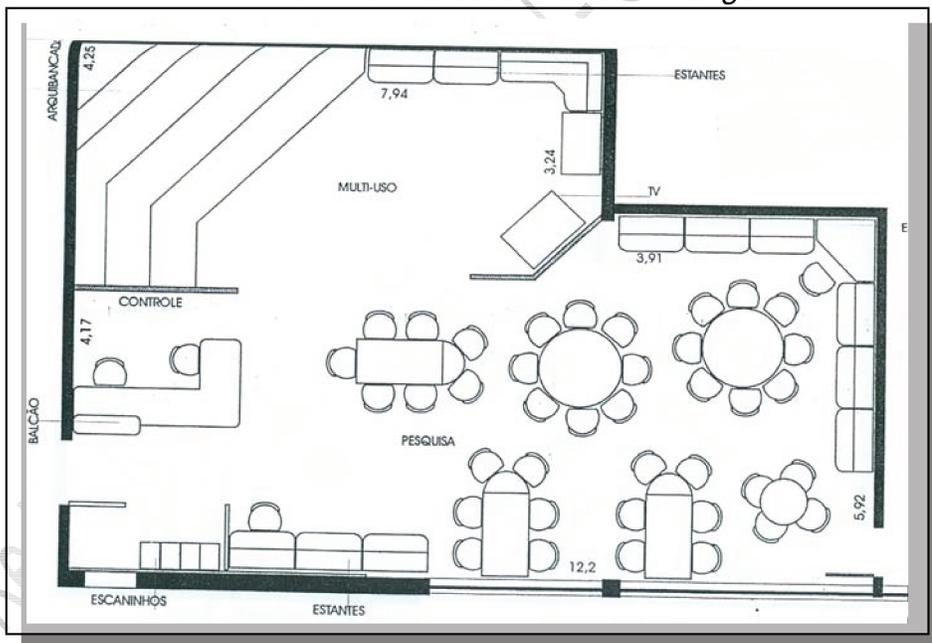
Planta baixa do estudo de lay-out 6 da Biblioteca Escolar Interativa EMPG Professor Roberto Mange
